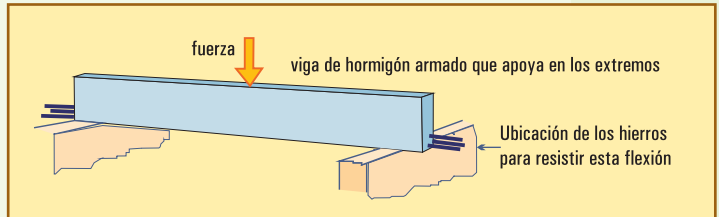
Ubicación de las varillas de acero en una viga de hormigón armado
